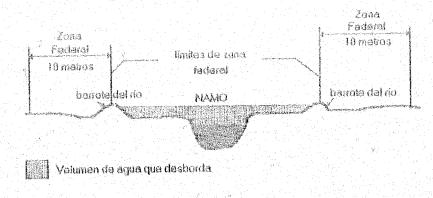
Demarcación de zona faderal para cauces en plunicie.
